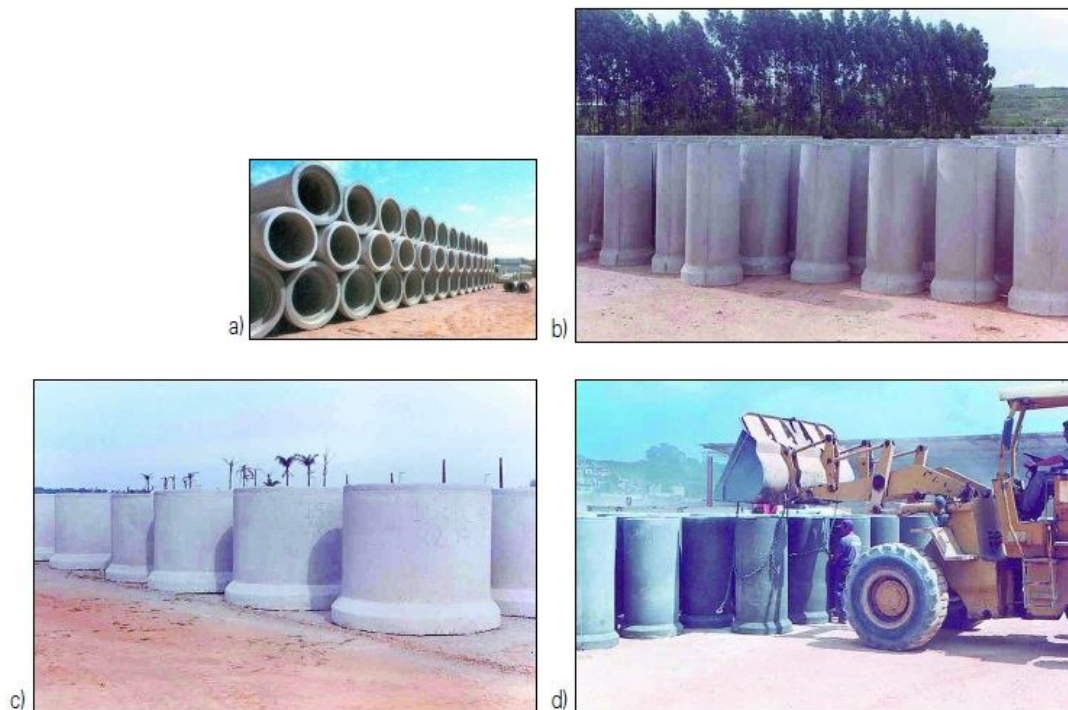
Armazenamento de tubos circulares de concreto
